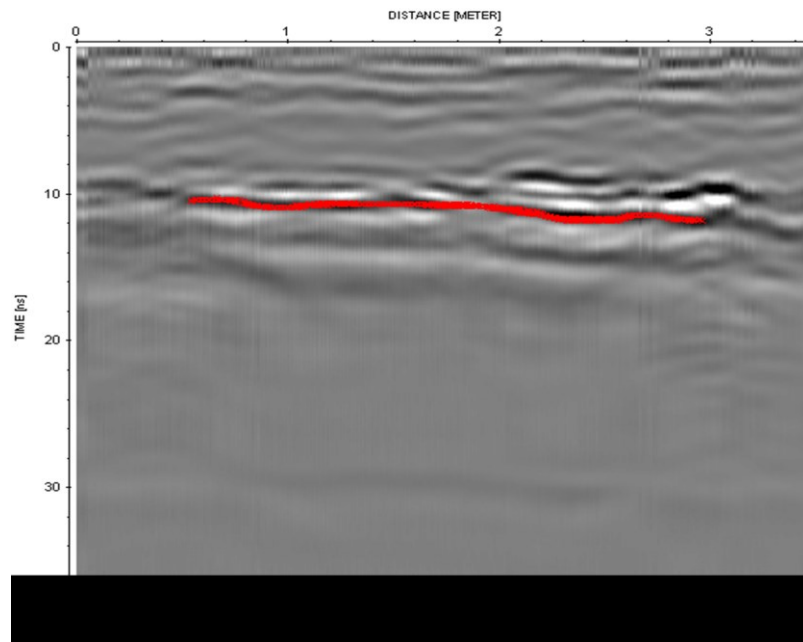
Exemple de l'opération de Pick sur l'extrados d'une dalle
